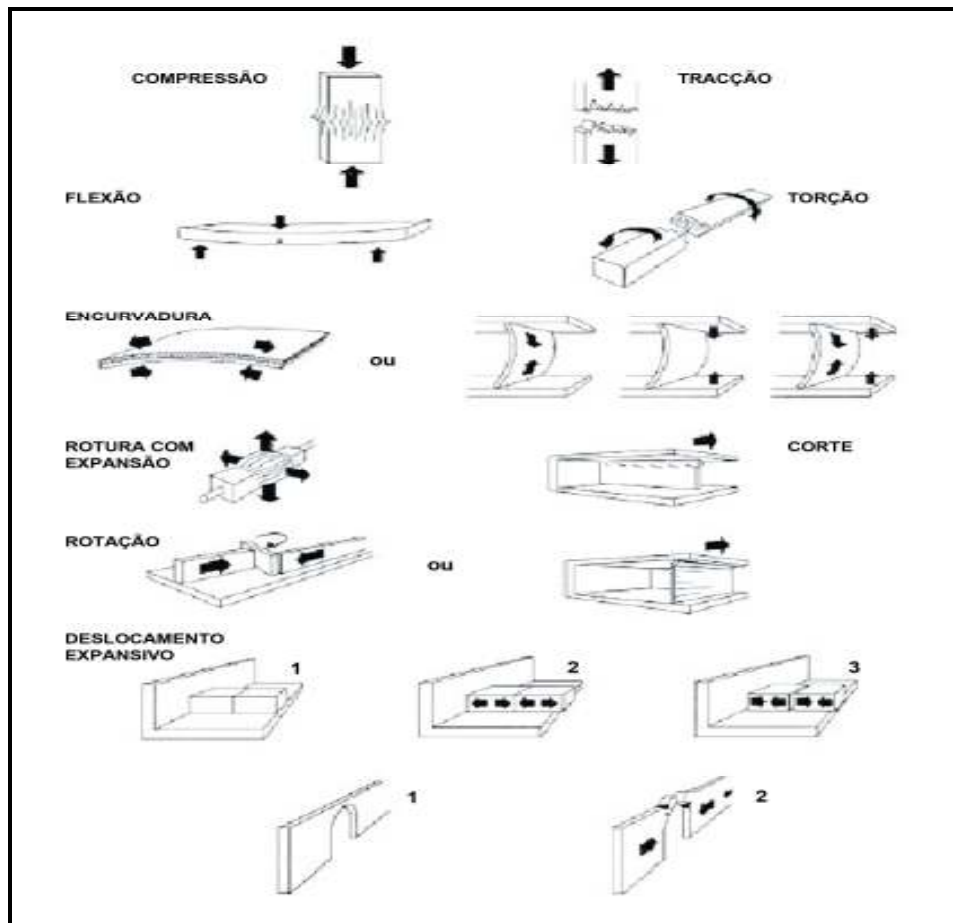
BONSHOR, R. B.; BONSHOR, L. L. - “Cracking in Buildings”. BRE, Garston, 1996, citado em [5].
